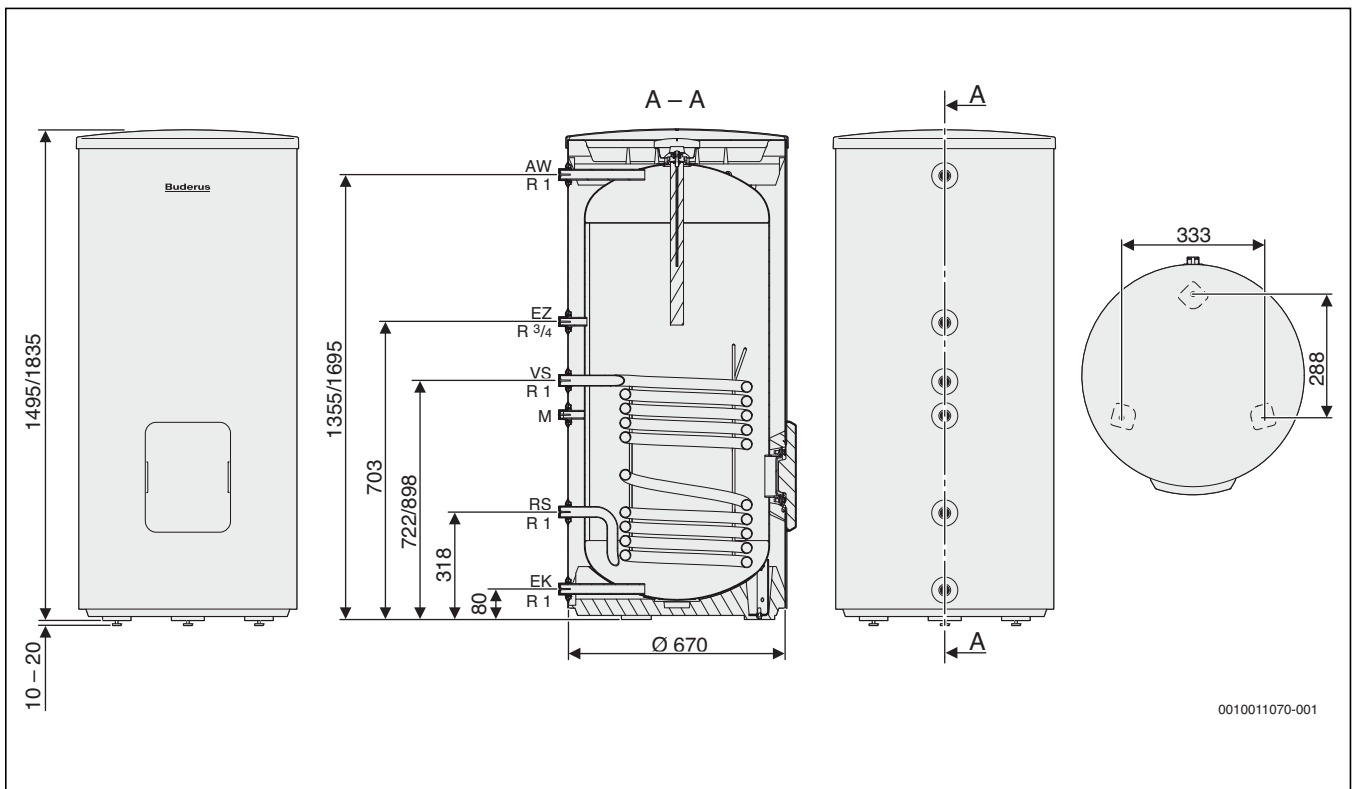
Abmessungen und Anschlüsse Logalux SU300/400.5 (Maße in mm)
